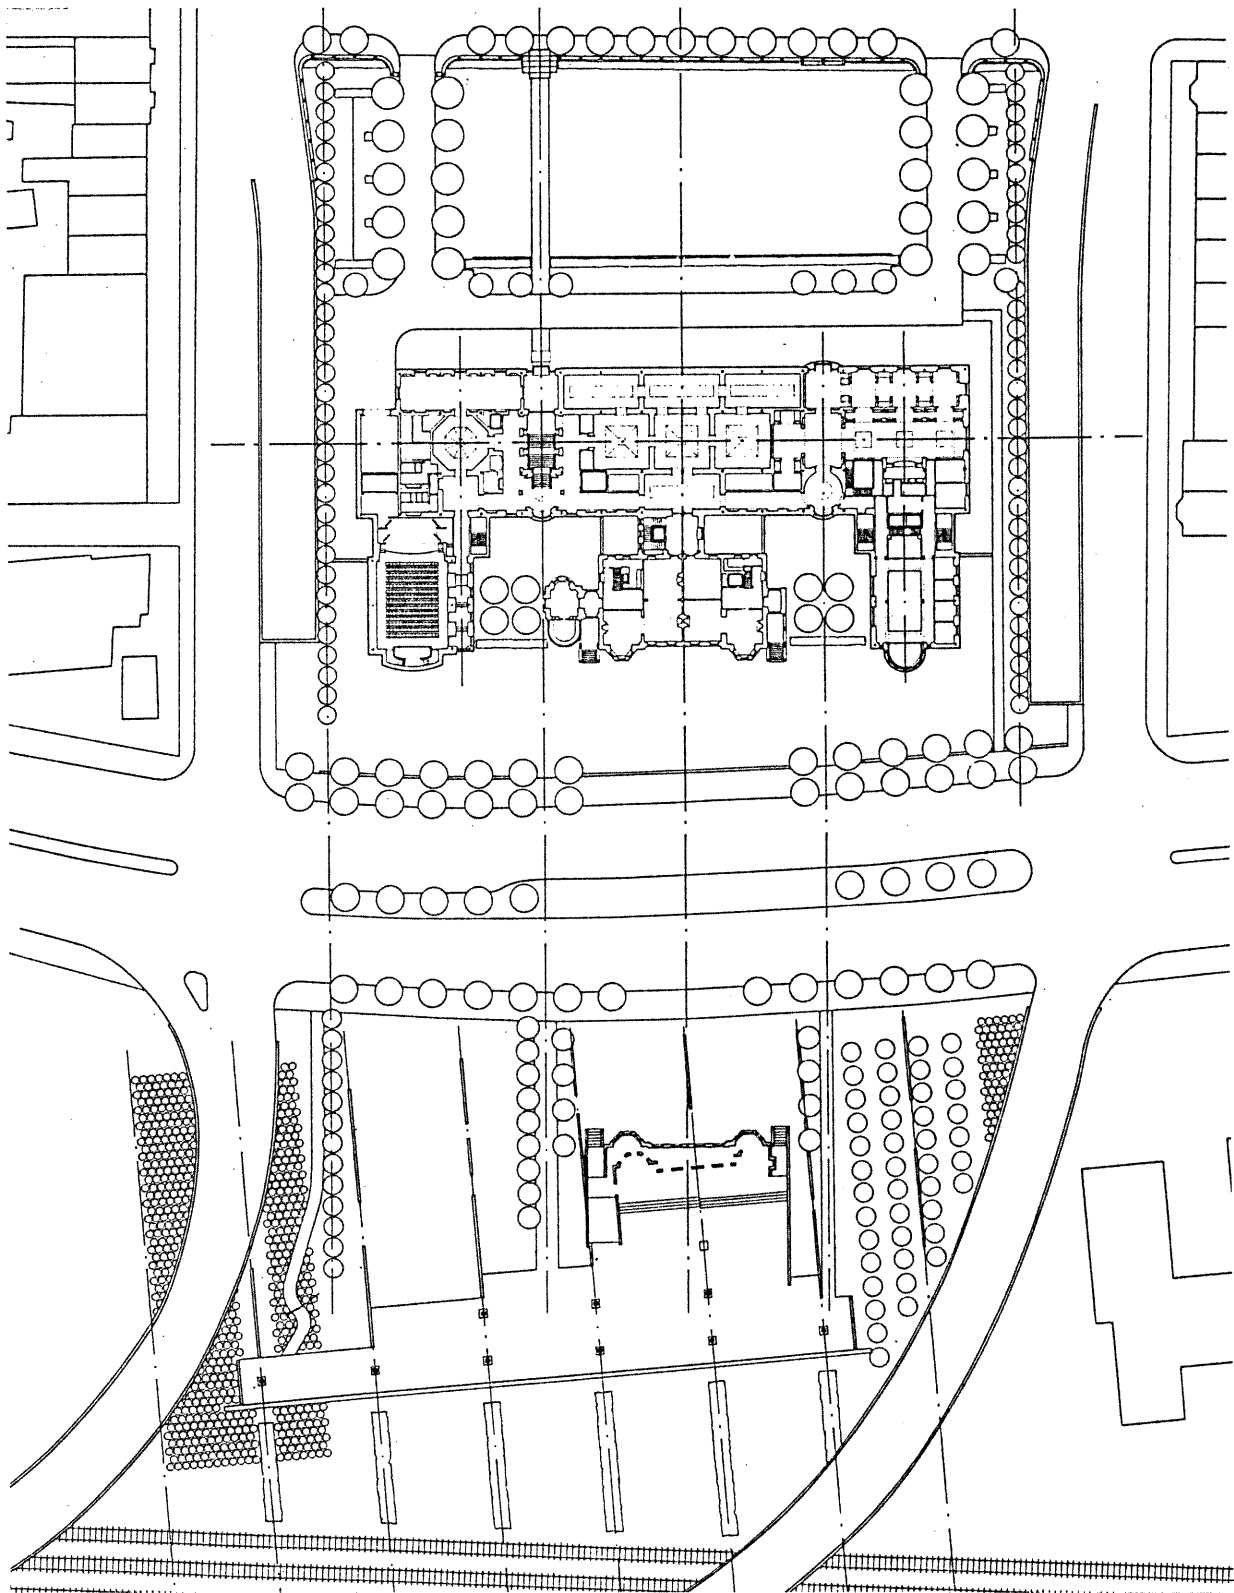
Plan du Jardin et du Centre Canadien d'Architecture.
